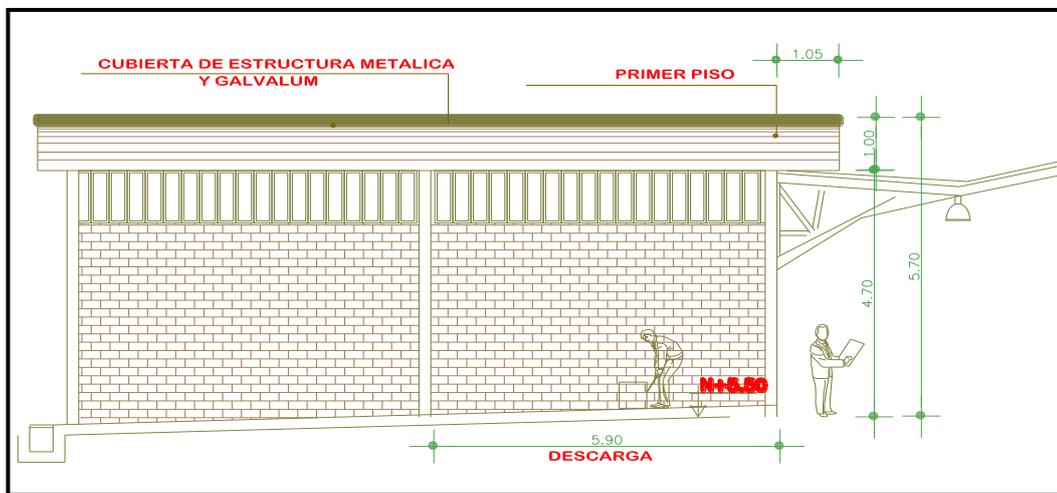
Vista corte de área de descarga planta de reciclaje
